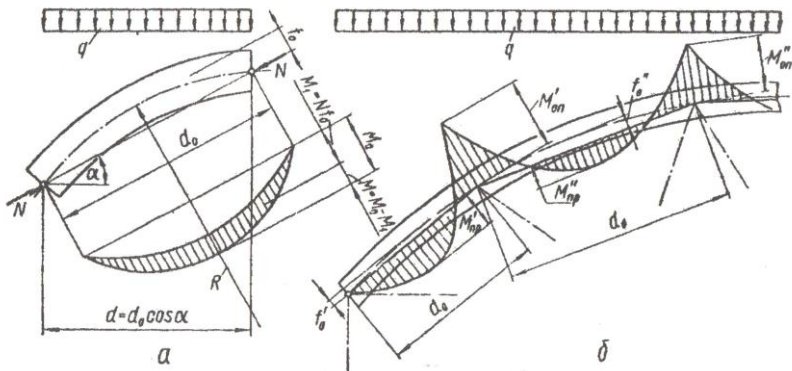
Расчетные схемы изгибающих моментов в верхнем поясе сегментной фермы:
